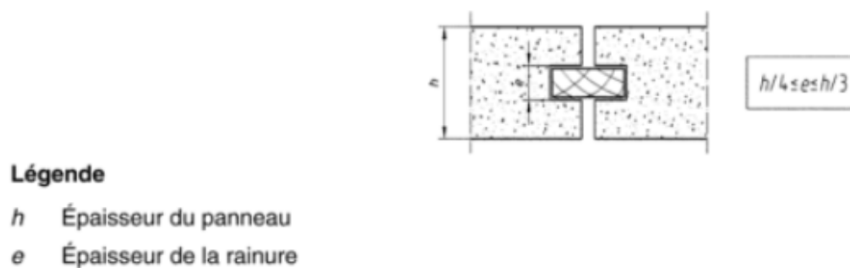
Schémas d'assemblage de panneaux par rainure et fausse languette
